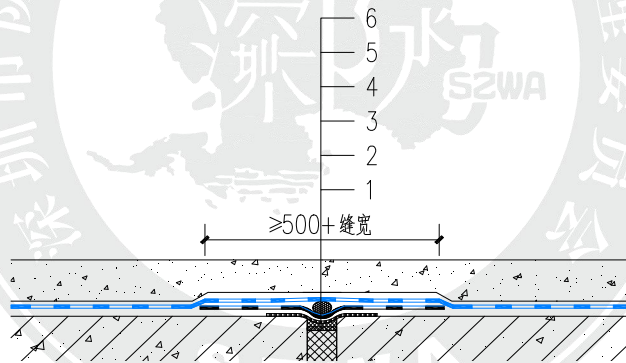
顶板或侧墙变形缝防水构造示意图
